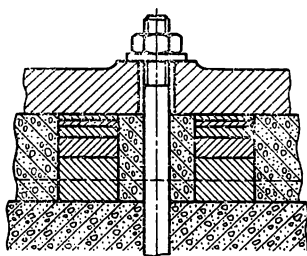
Установка подкладок с двух сторон фундаментного болта
